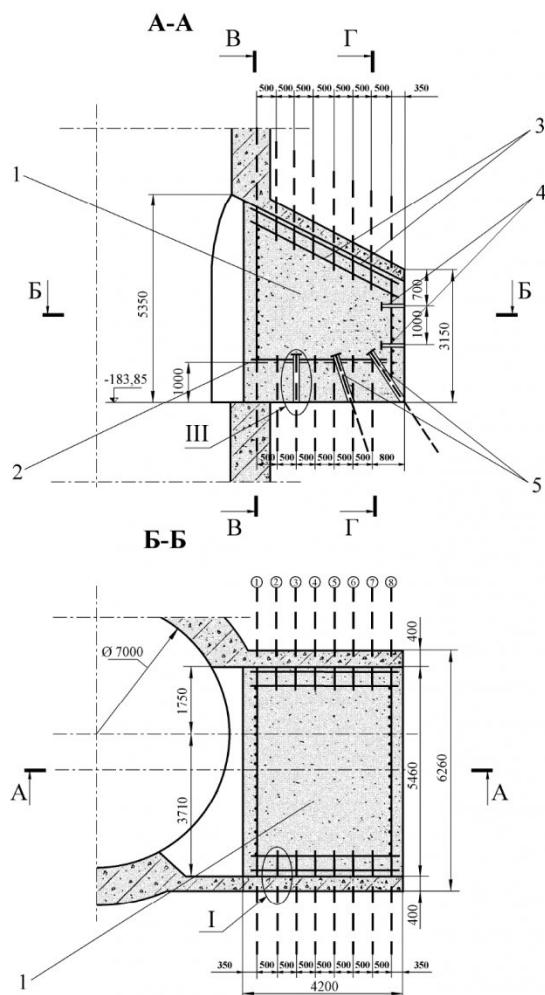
Схема расположения арматуры, железобетонных анкеров и кондукторов:
